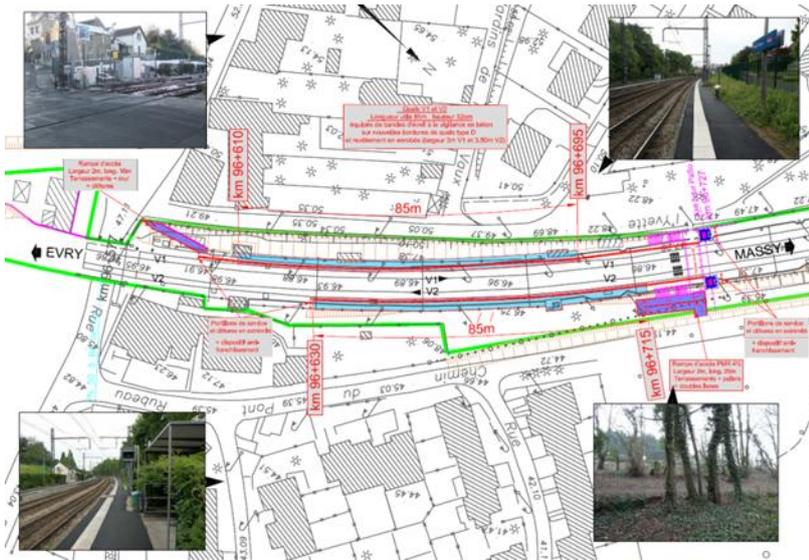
Plan d'infrastructure de la station de Petit Vaux aménagée
